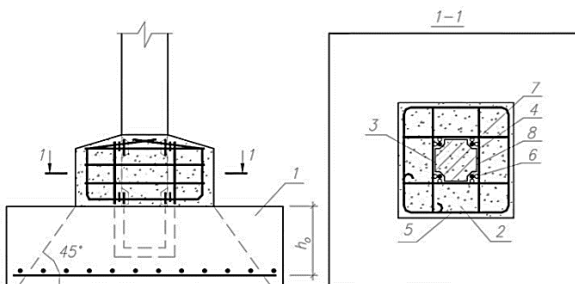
Схема усиления плит устройством железобетонной рубашки:
